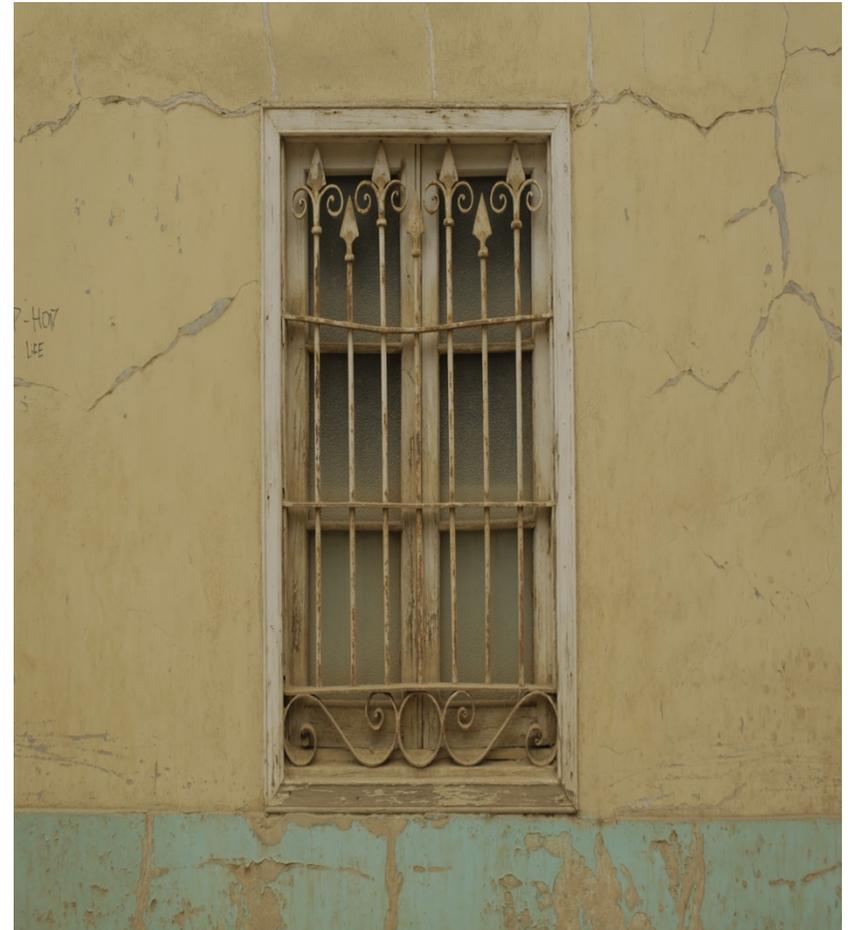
, detalle barrotes casa Zanatán. Autor: Guillermo Ribbeck.
